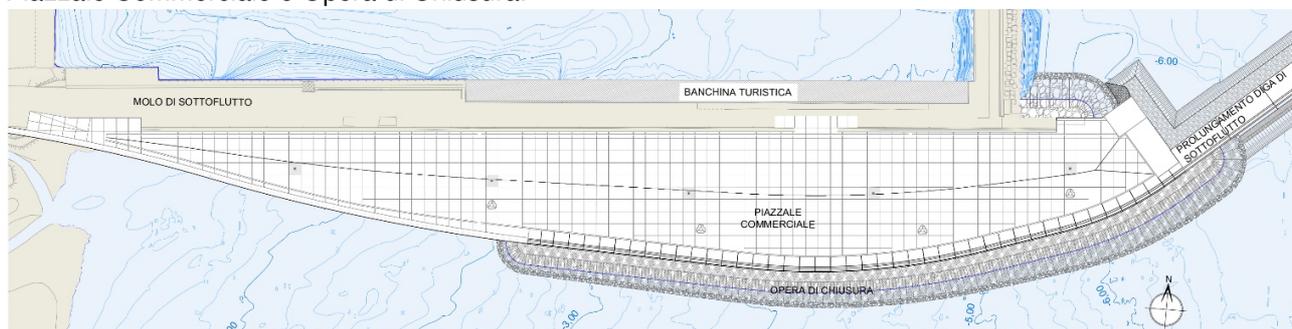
Progetto Esecutivo: Piazzale Operativo - Planimetria generale di progetto
